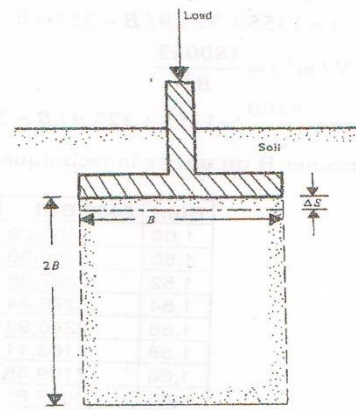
Définition de la vitesse de déformations sous une fondation.
